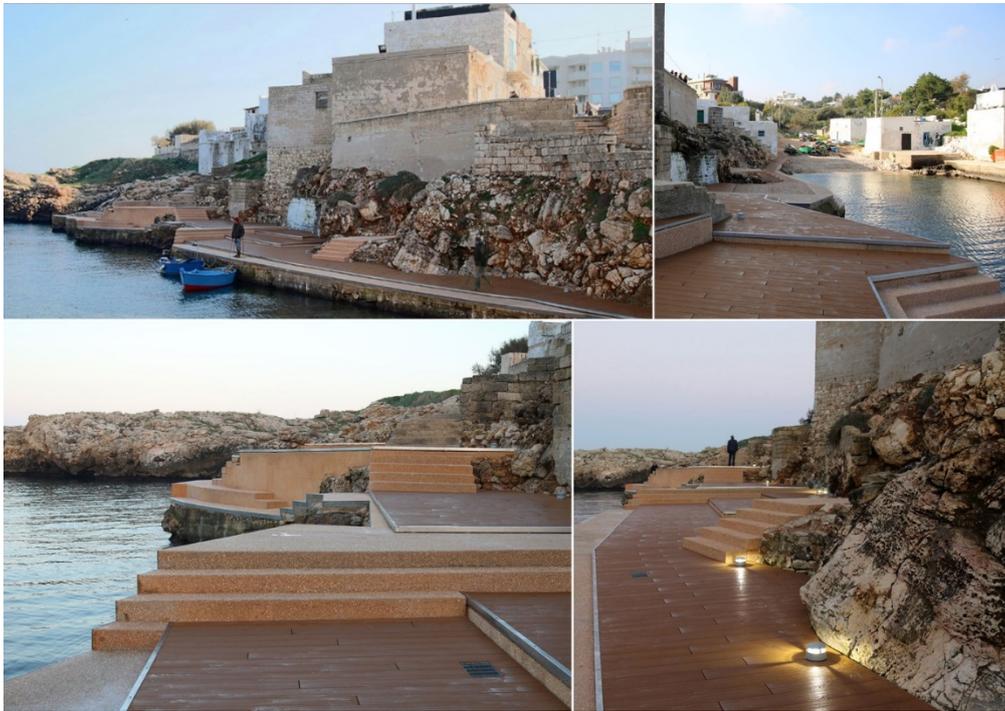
| Collage del progetto “Cala Paura” dell’Arch. Luca Labate, realizzato a Polignano (BA).
